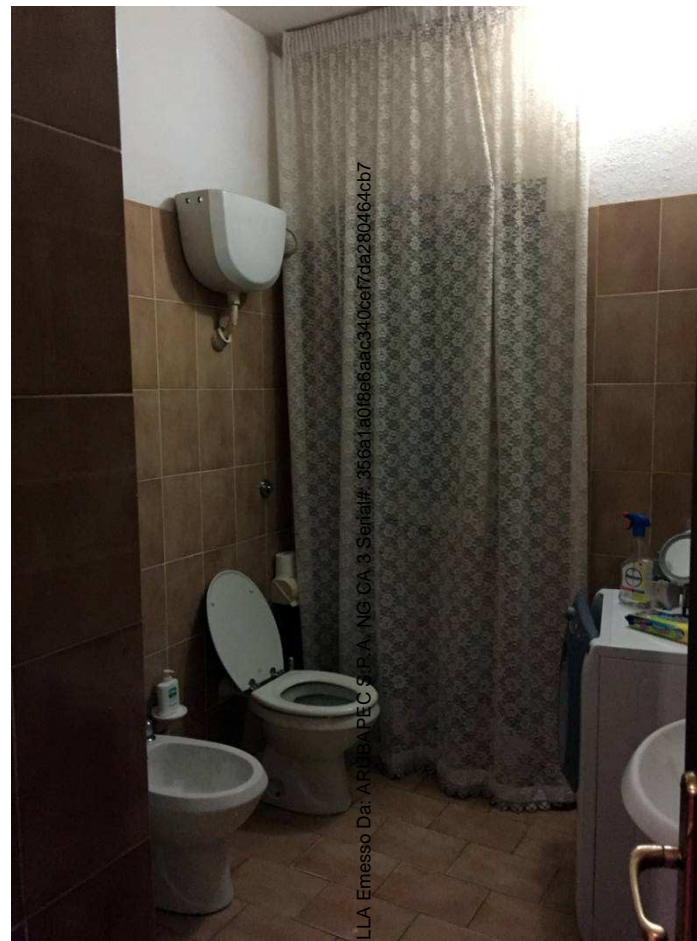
(Sub. 4) Rivestimento pareti con piastrelle in gres
